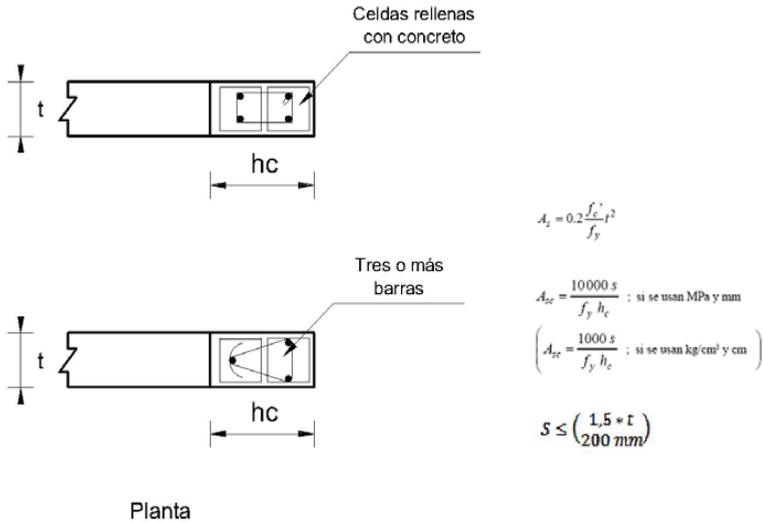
Distribución de refuerzo Vertical y Horizontal. Detalles de encuentro de muros, ubicación de estribos y conectores
